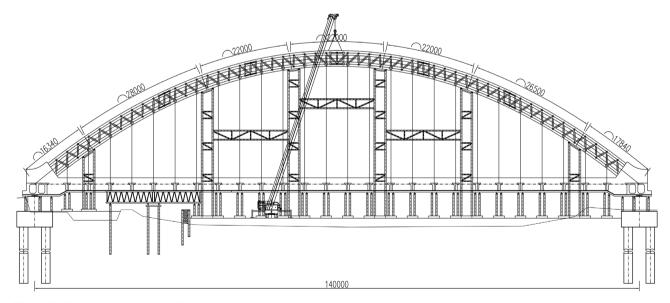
Construction diagram of arch rib erection 图 3. 拱肋吊装施工示意图
